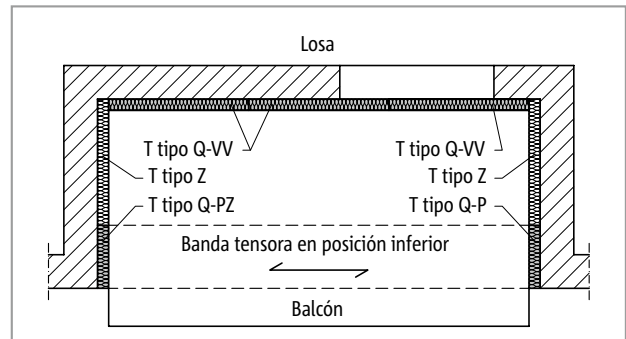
Schöck Isokorb® T tipo K: Logia con apoyo en tres lados y banda tensora
